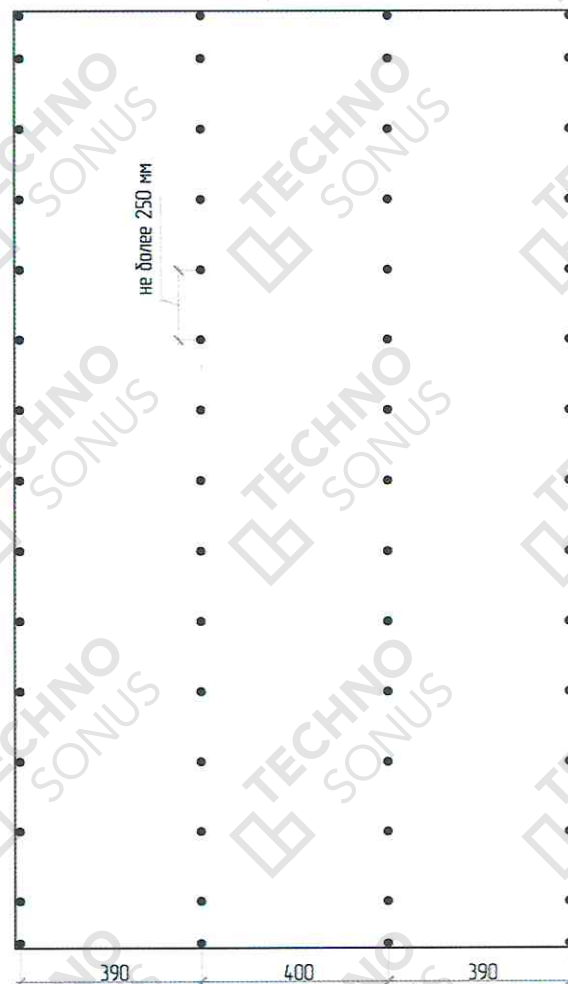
Схема расположения саморезов при двухслойной облицовке ГКЛ/3
